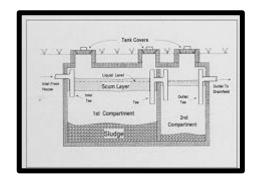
Fosa de cámaras en serie de fondo plano
